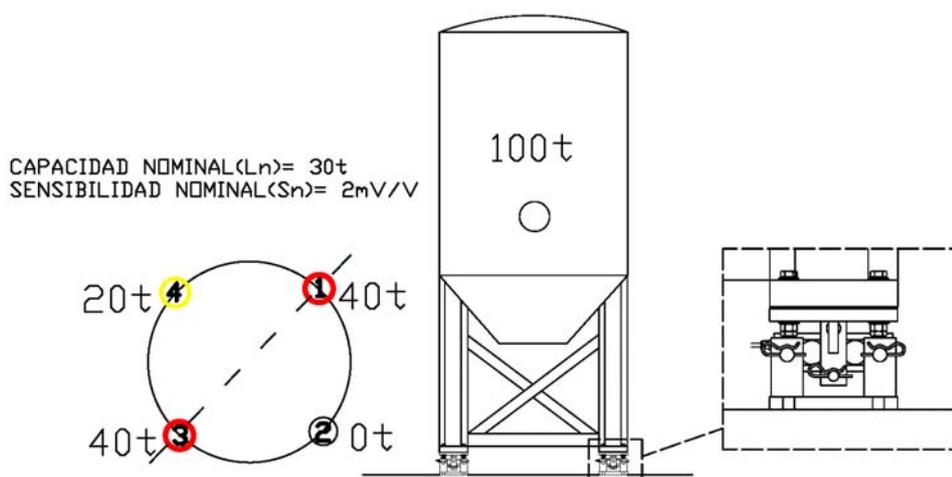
Vista de la planta y vista frontal de un Silo desnivelado
